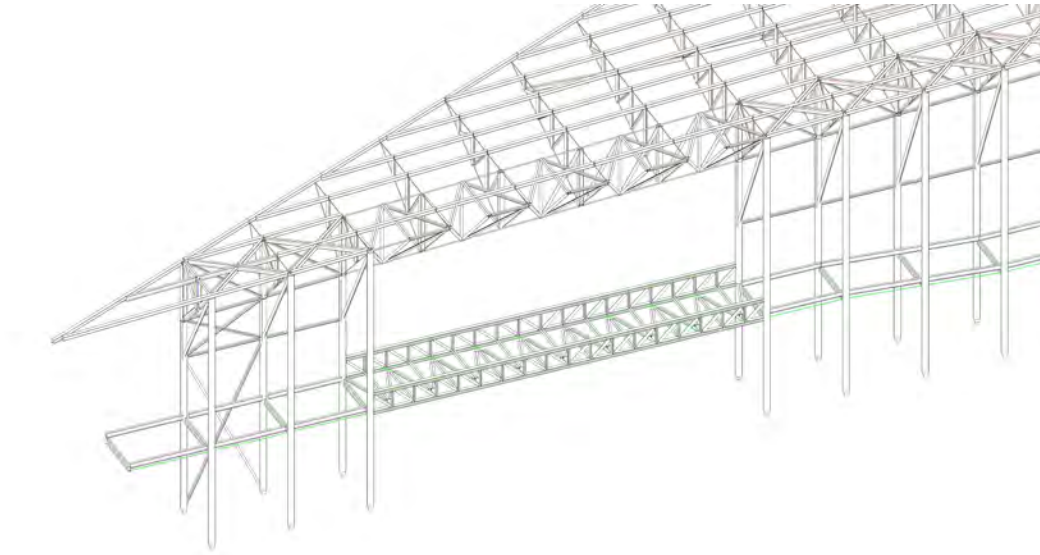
Errori nel trasferimento della trave reticolare spaziale.
